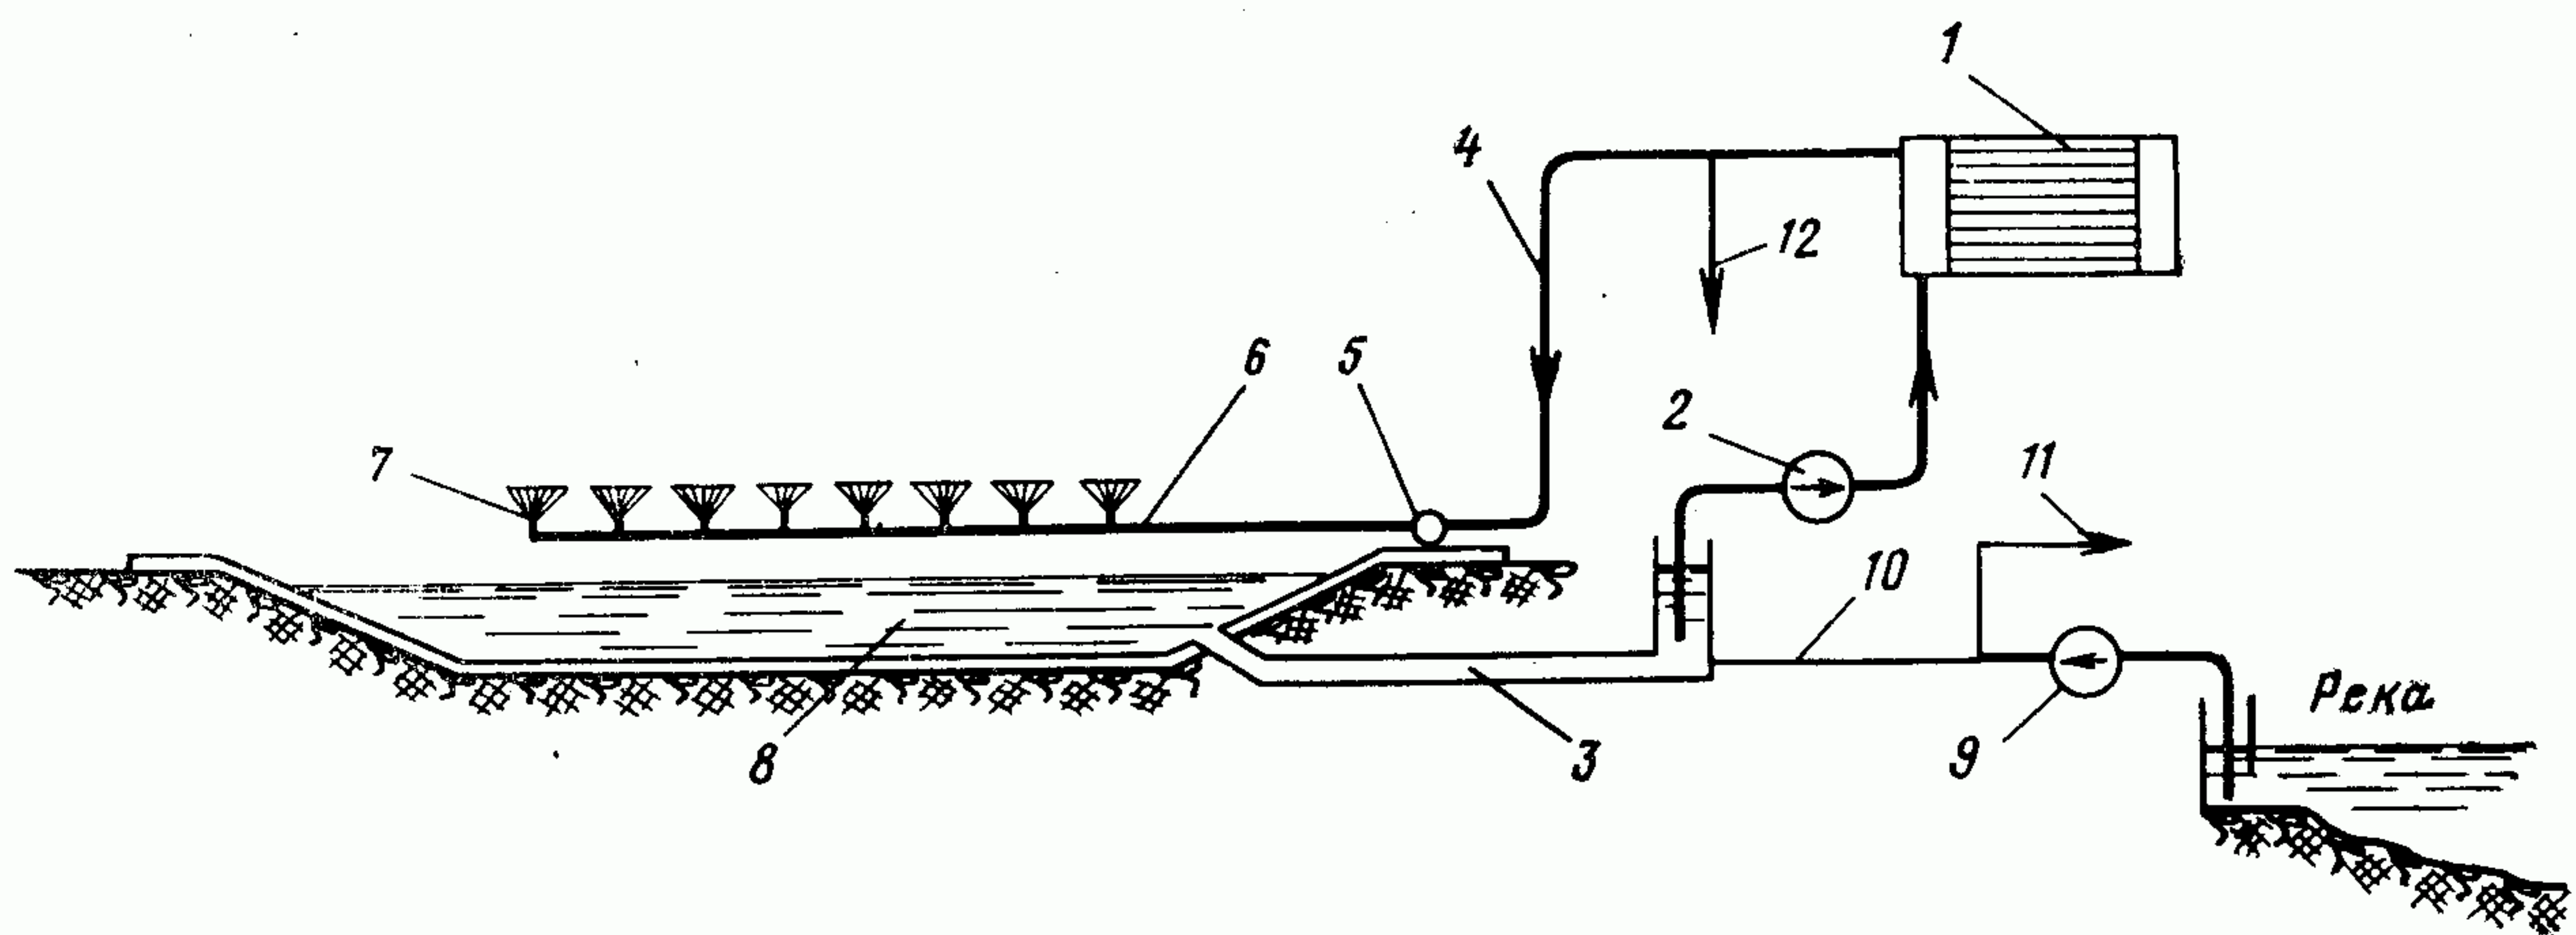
Схема оборотного водоснабжения с брызгальной установкой.
